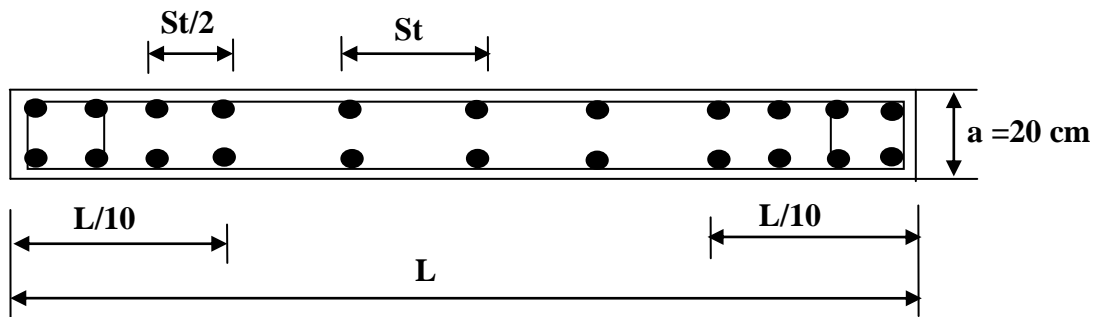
Disposition des armatures verticales dans les voiles.
